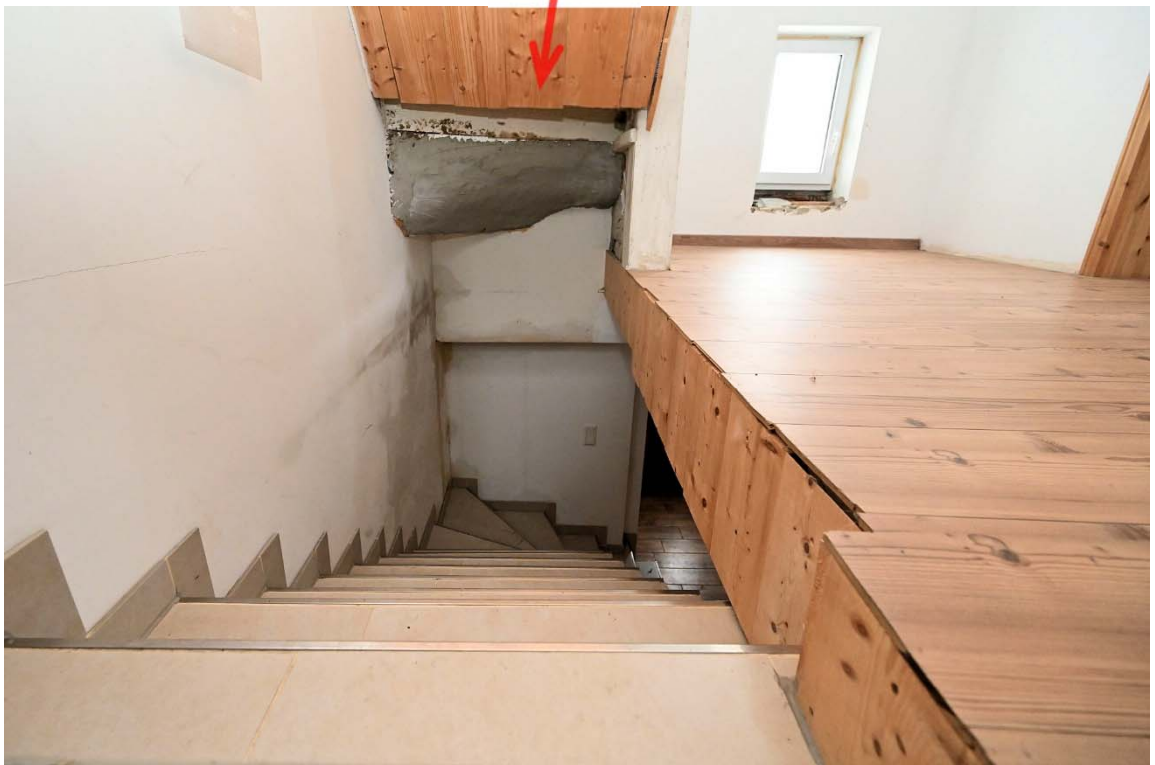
Wohnhaus (A), Dachgeschoss, Flur, Detail Verkleidung Treppenaug e / Nässe schaden unterhalb der Bodentreppe und geringe Durchgangshöhe zum EG
